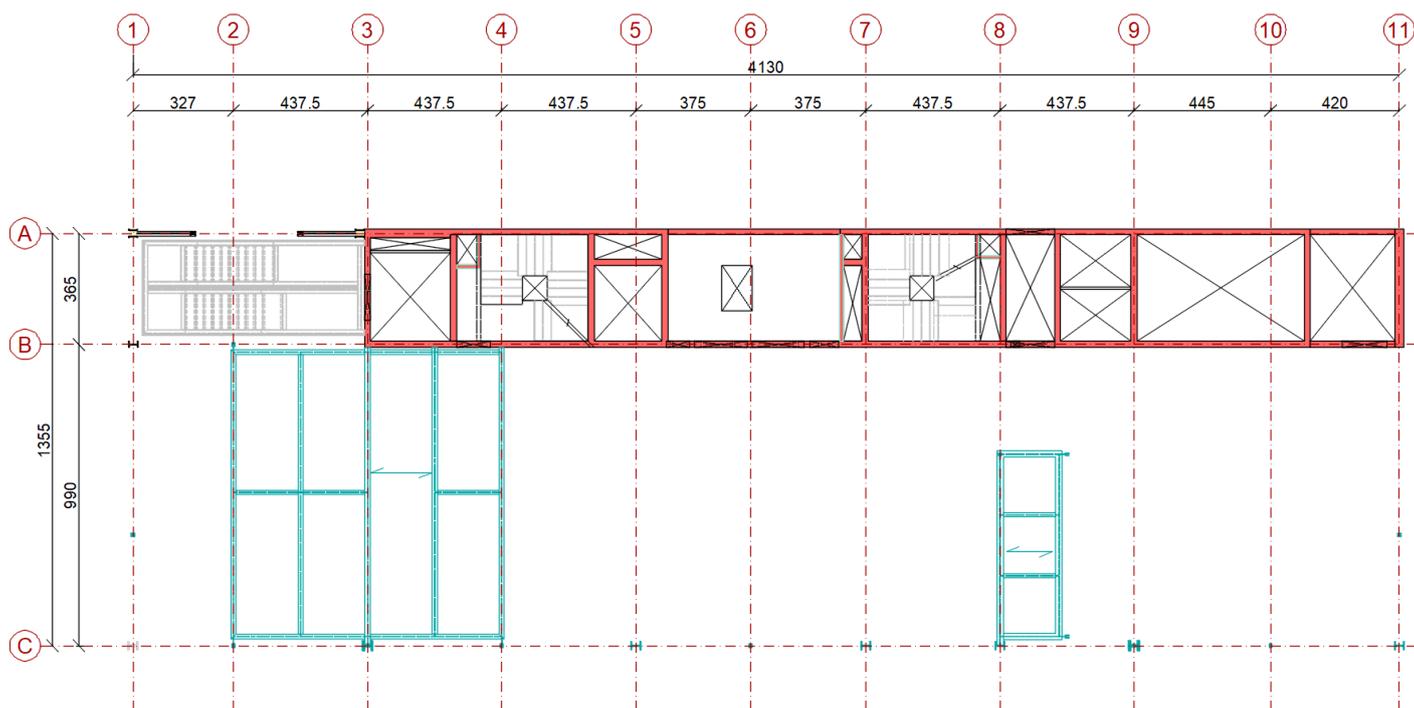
Planta de Arquitetura – Segundo pavimento: salas de aula
